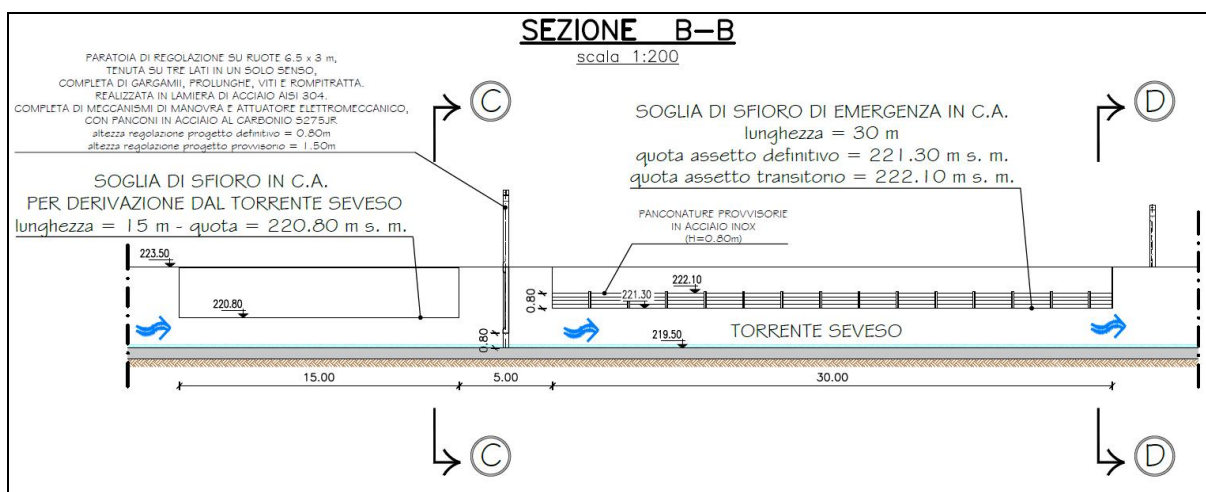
Sezione longitudinale di progetto (B-B) dell'opera di presa dal T. Seveso
